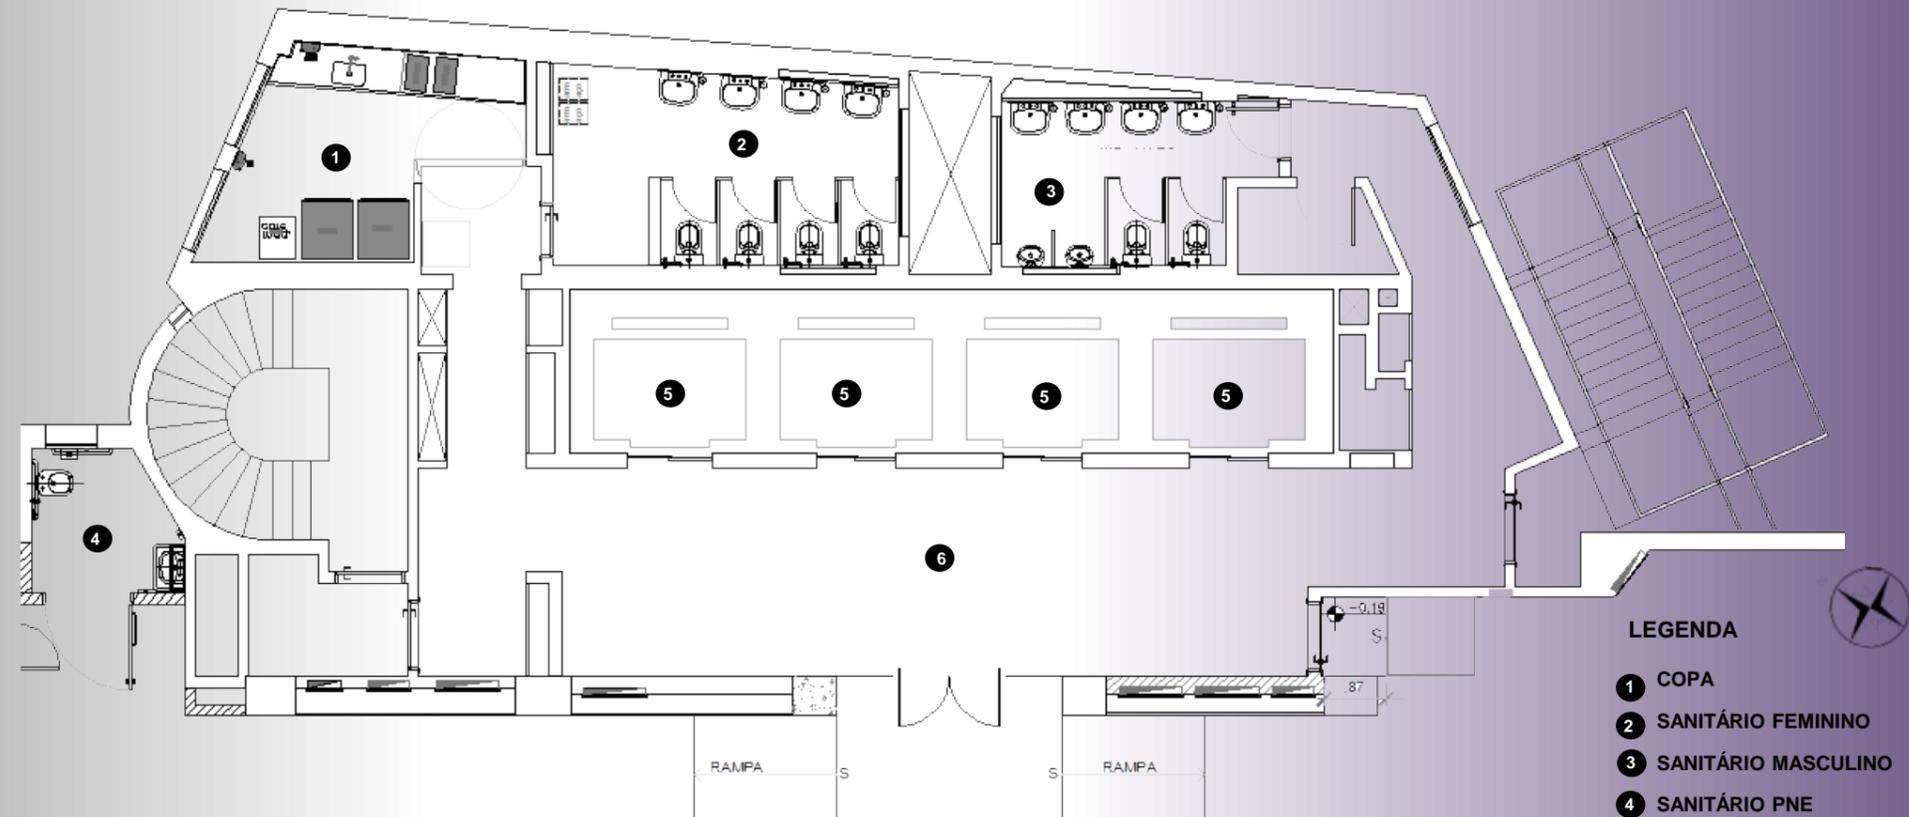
10º PAVIMENTO - BANHEIROS
